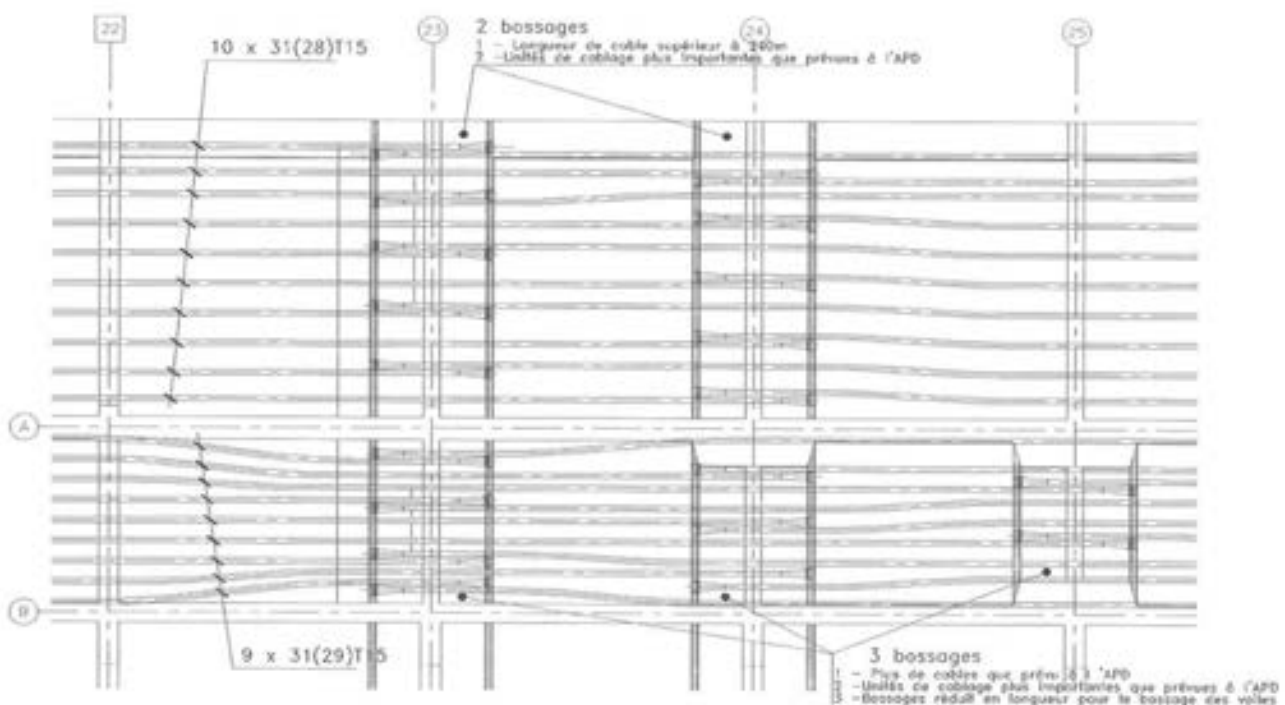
Vista en planta del refuerzo del Plot 5.
